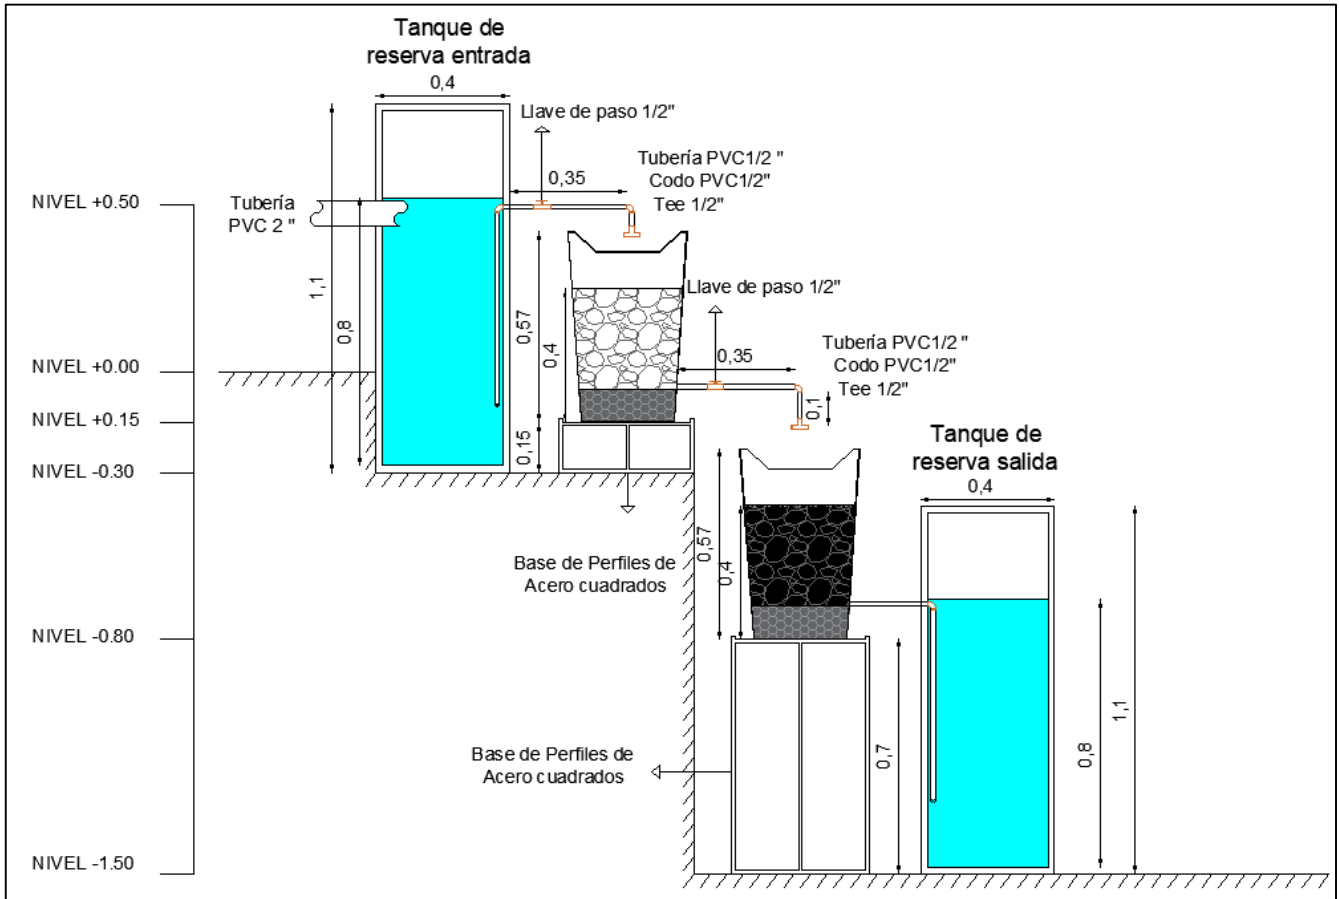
Diseño de planta de tratamiento – Alternativa 2 (Katukiza)
